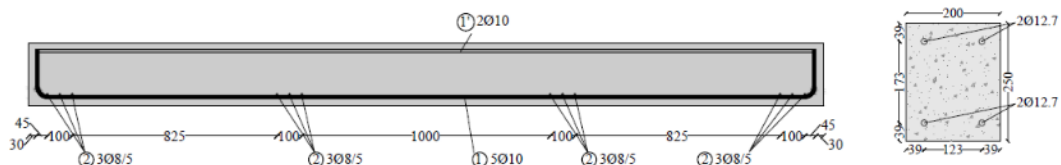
Disposición armadura longitudinal de GRFP. Grupo 1. Ensayo armadura pasiva.
